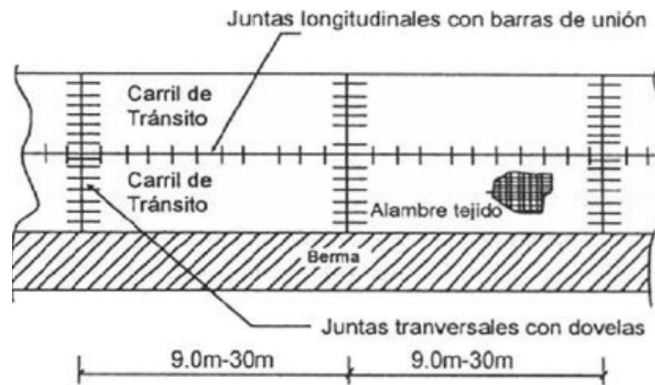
Composición de un pavimento articulado de concreto reforzado (Fuente: Menéndez (2012))
